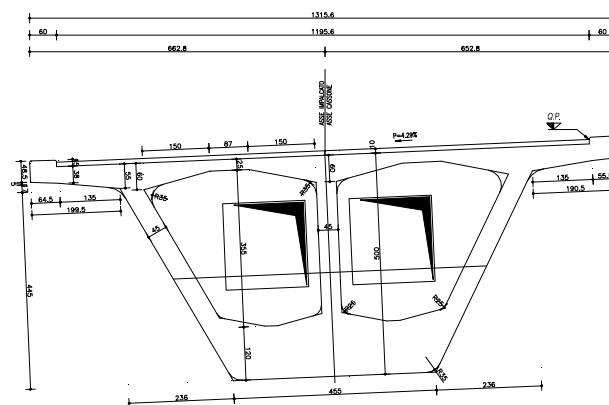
Sezione trasversale impalcato in asse pila – Progetto Definitivo
